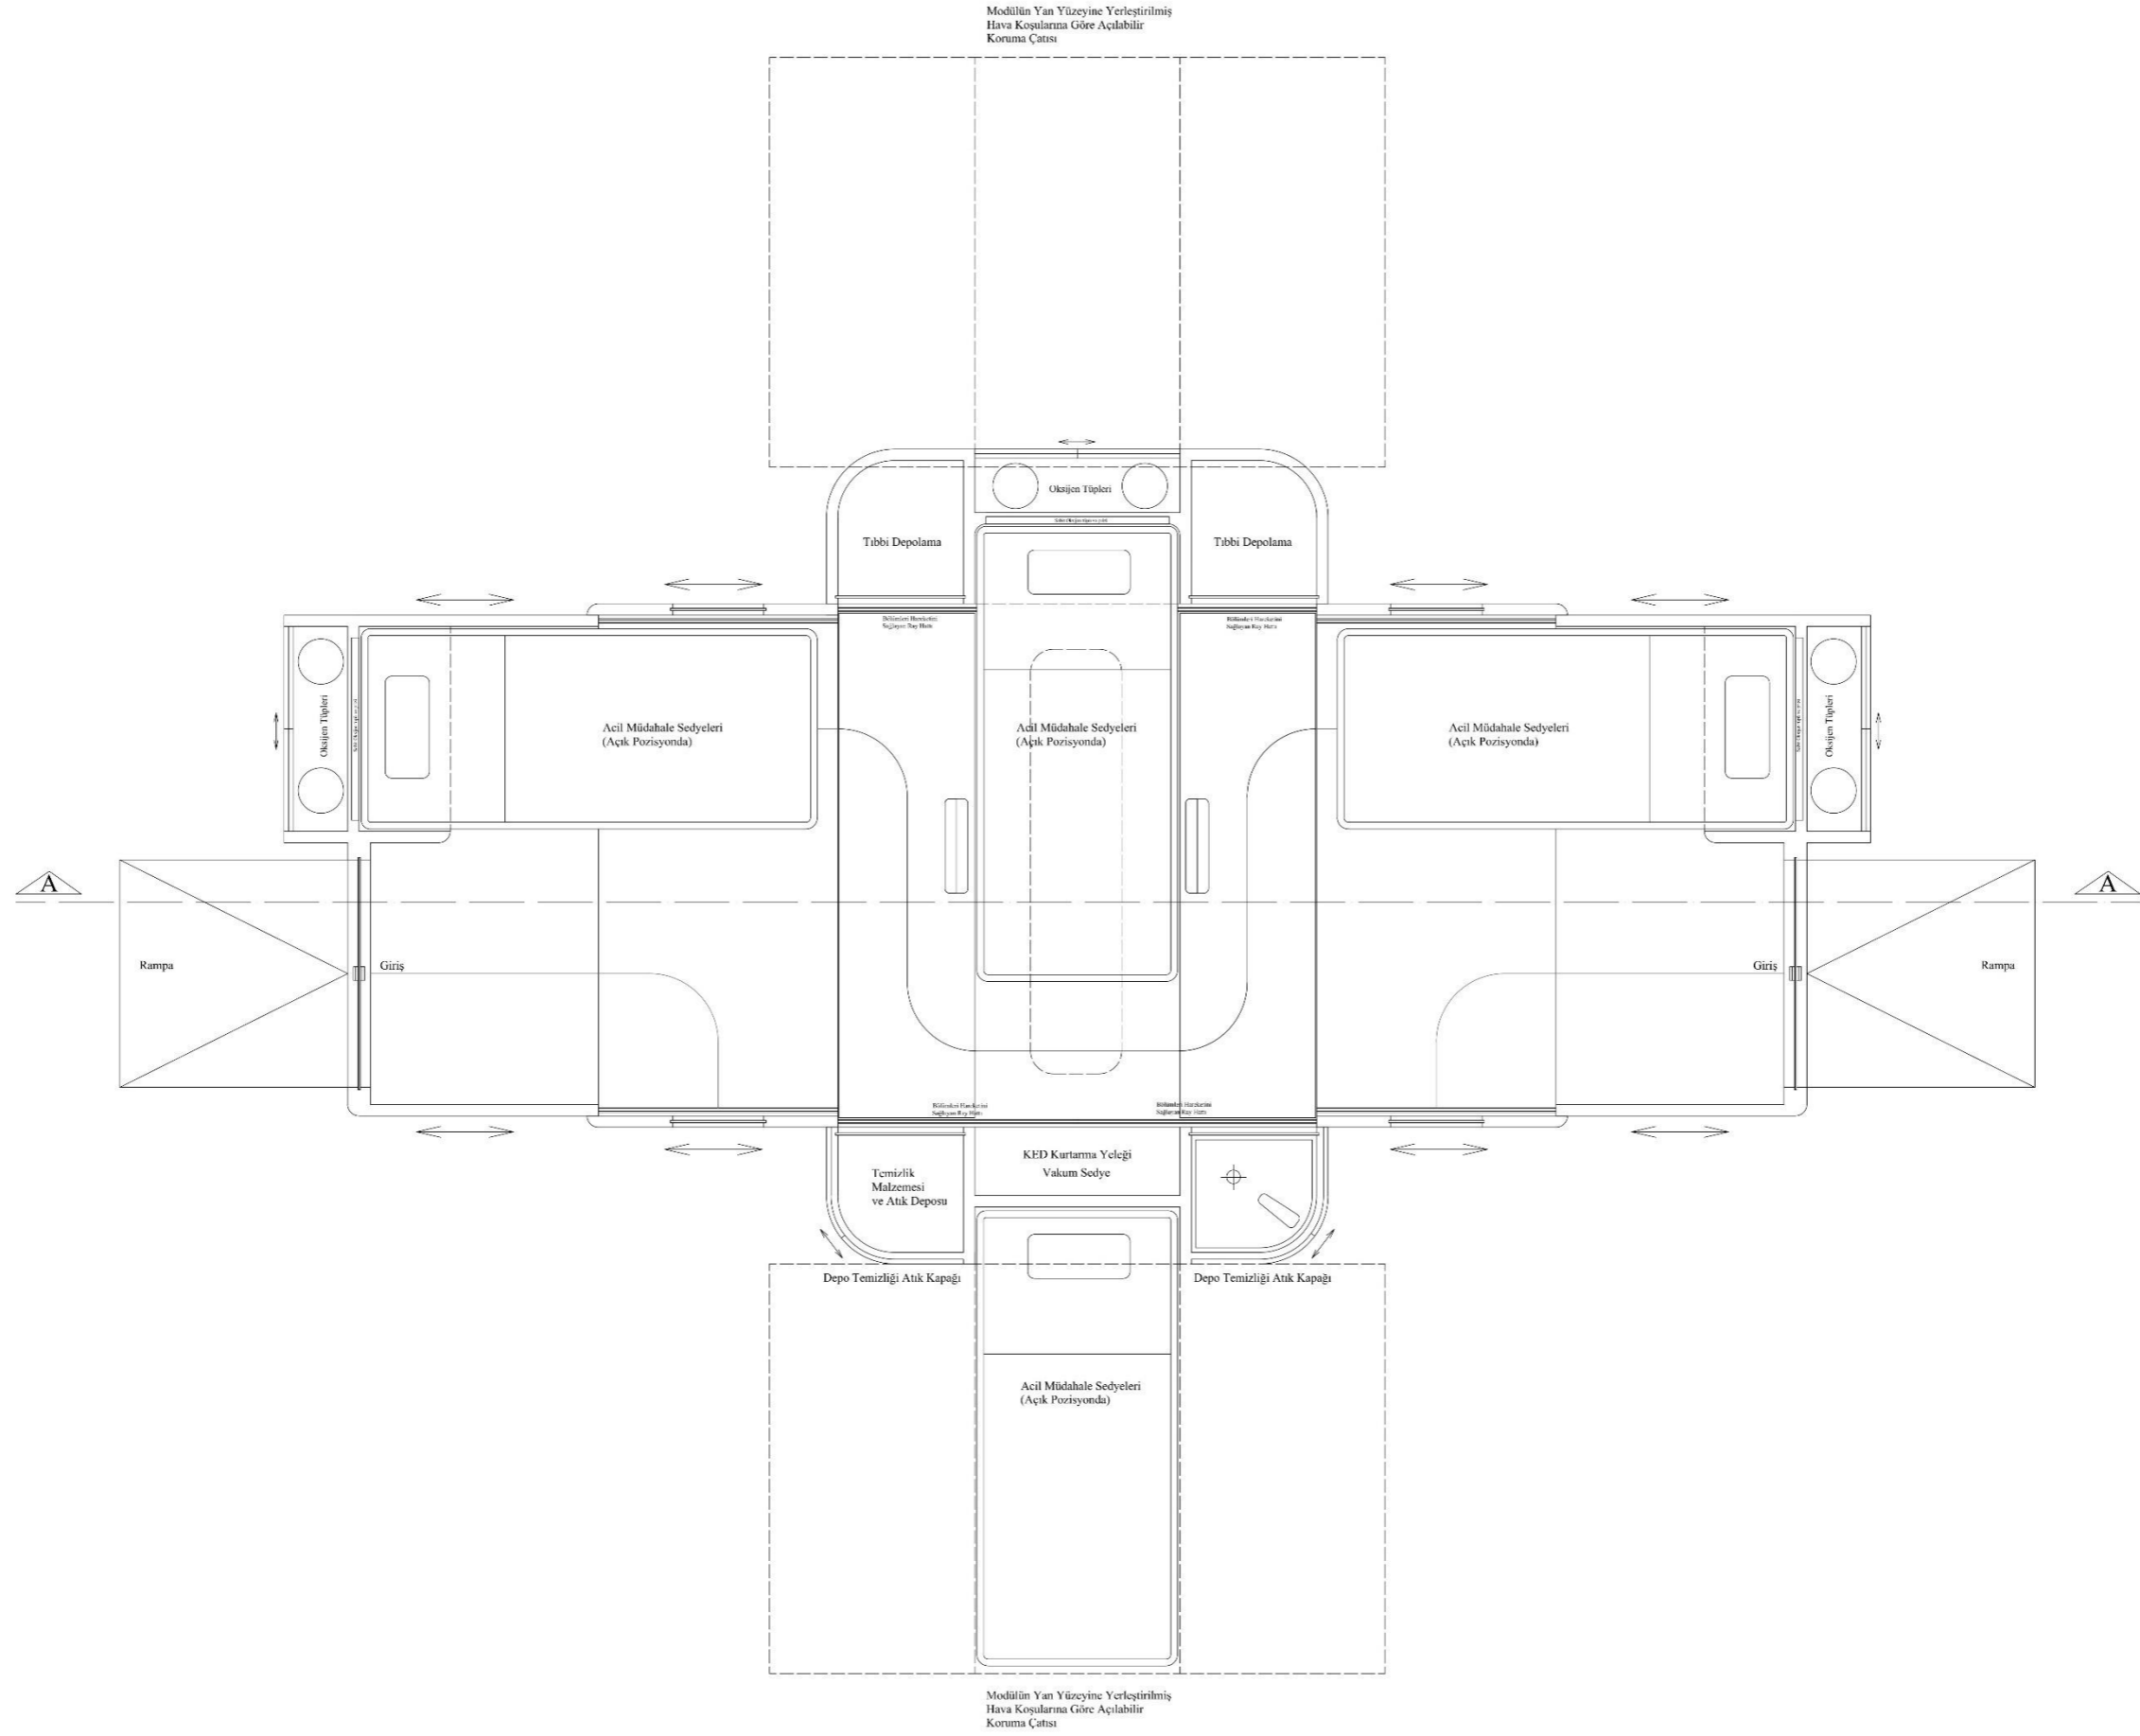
İçerisinde ıslak hacim bulunan acil durum müşahade modül planı - açık pozisyonda.
